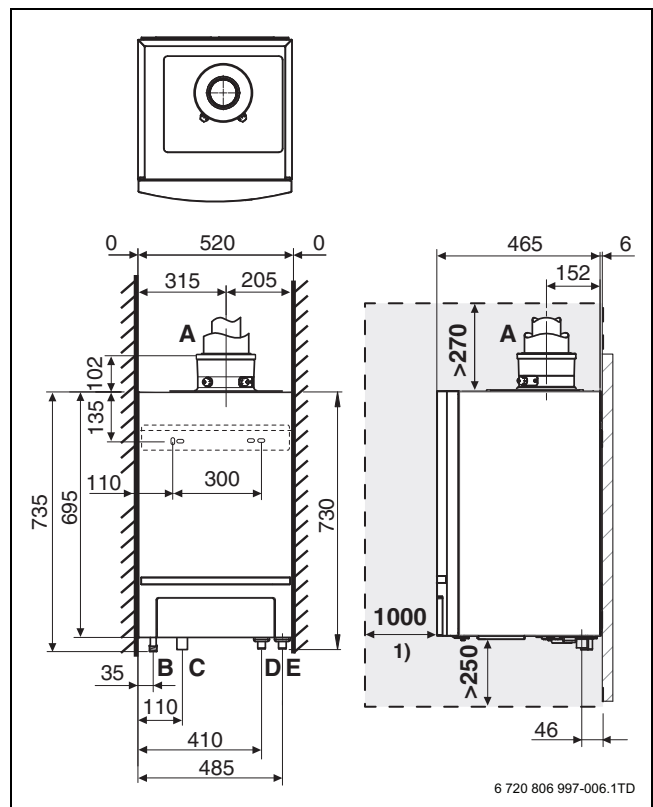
Abmessungen und Anschlüsse (Maße in mm)
